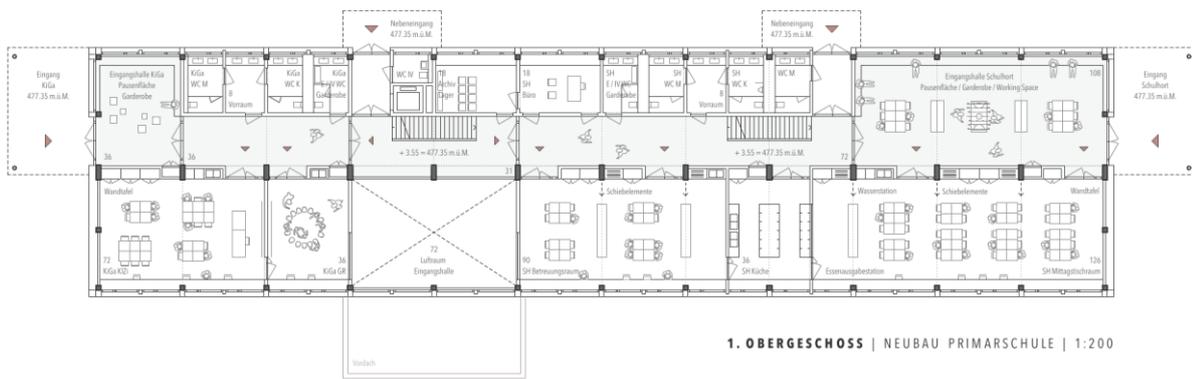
Neubau Primarschule, Grundriss 1. Obergeschoss
